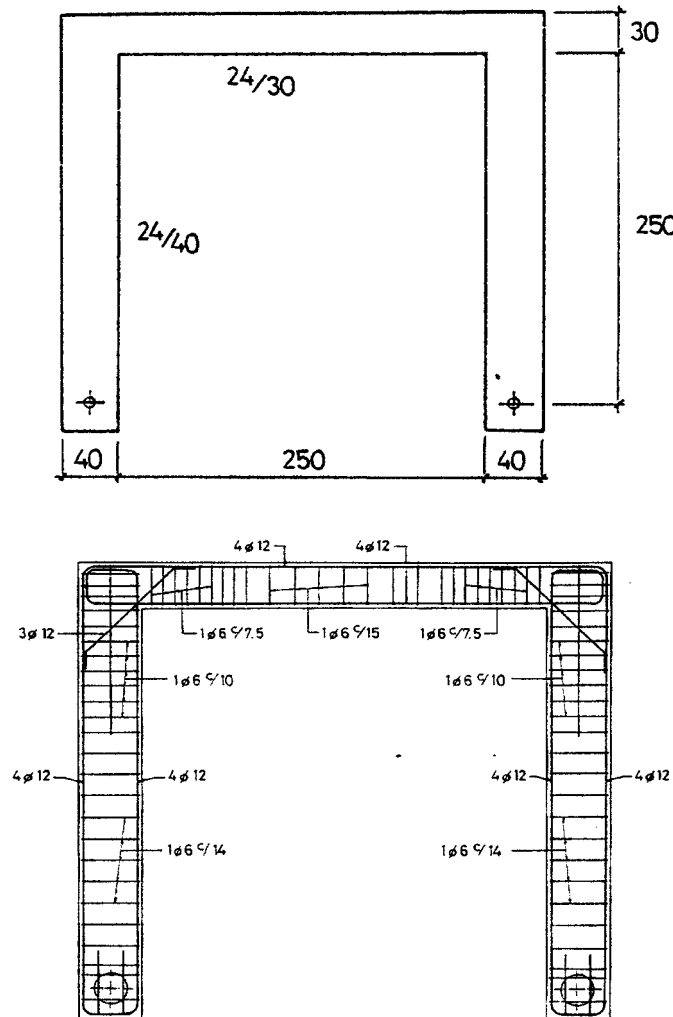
Dimensiones y armadura del pórtico simple de hormigón armado – corresponde a la figura 5 de Rubinstein et al, 1994.
